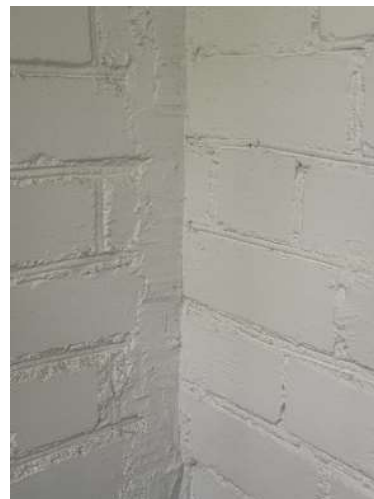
Отсутствие перевязки кладки стенок лоджий с наружной стеной здания (лоджия №11, свежий ремонт)
